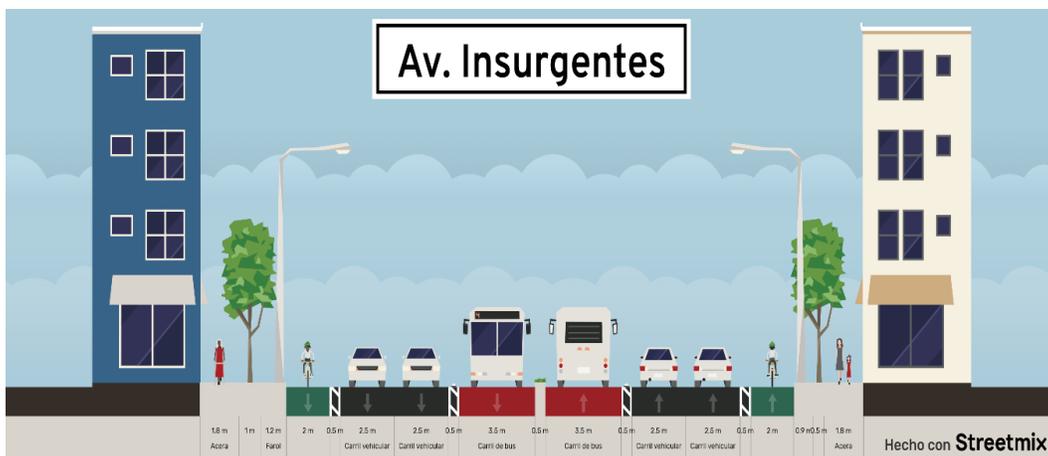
Corte Transversal Intersección 06 Gustavo Campa – Insurgentes Sur
